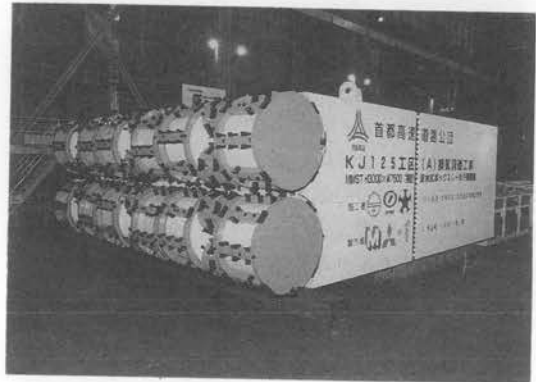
MMST工法用 横3連 矩形断面 シールド掘進機
